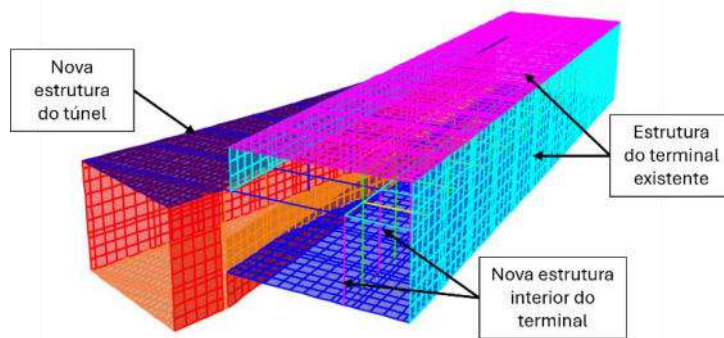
Vista 3D: modelo Estrutural desenvolvido em SAP2000.
